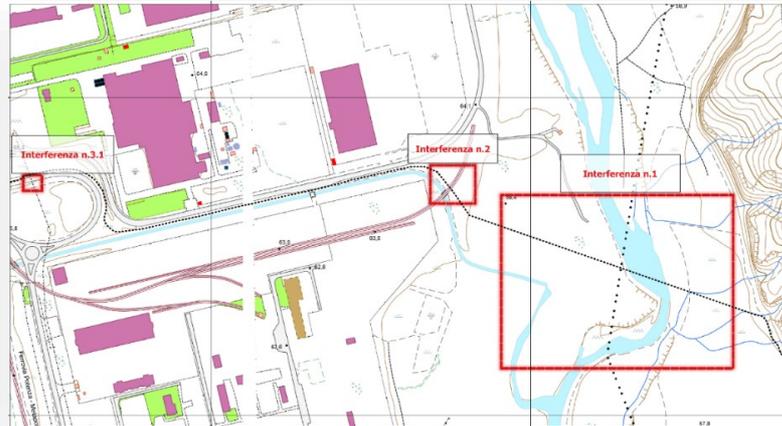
Estratto dell'elaborato A.12.a.21.a Planimetria con individuazione di tutte le interferenze
